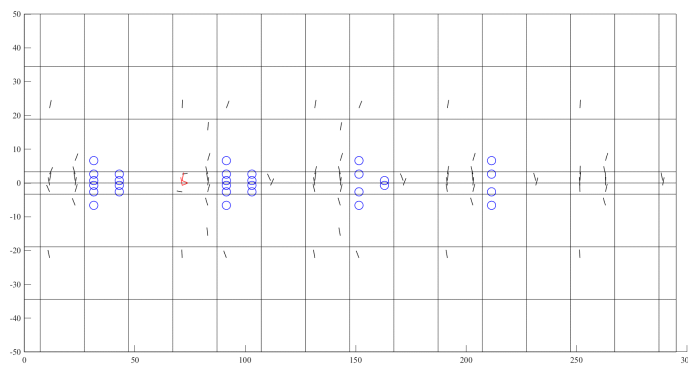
Padrão de fissuração na camada inferior da laje de concreto (viga B1GB20), (passo 18)
